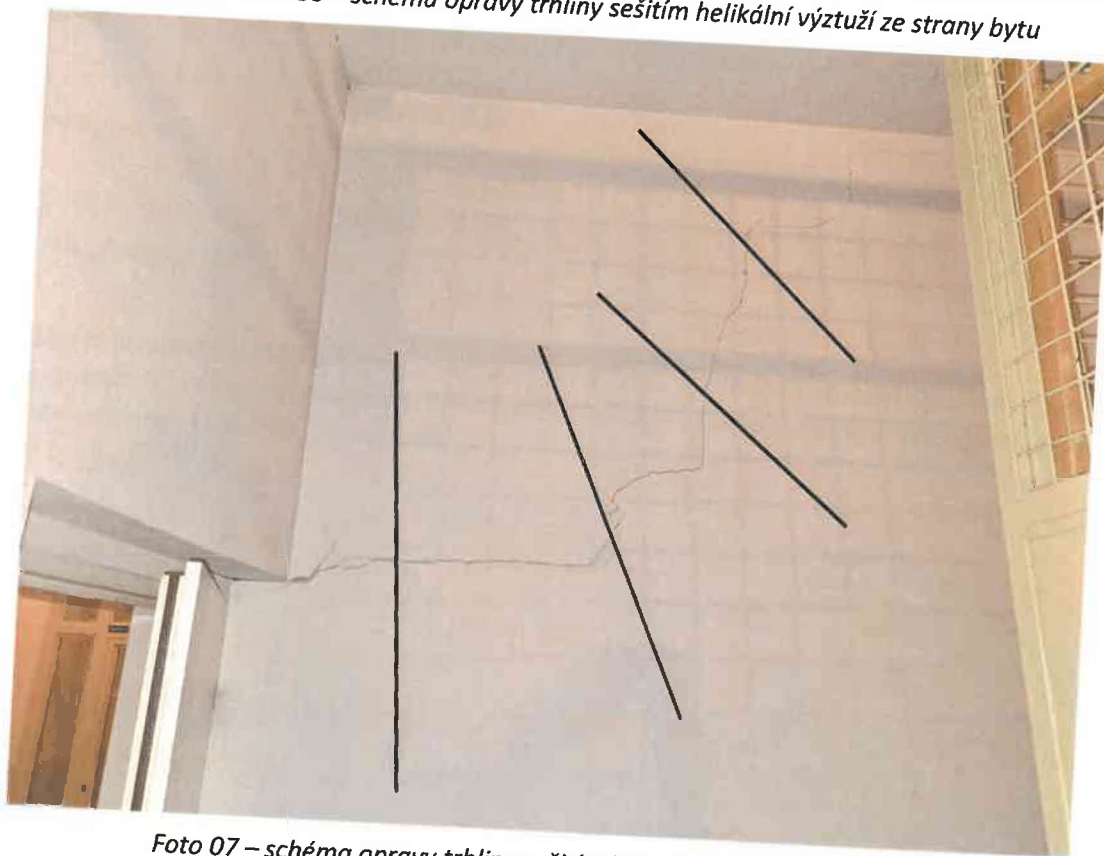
schéma opravy trhliny sešitím helikální výztuží ze sklepního prostoru
